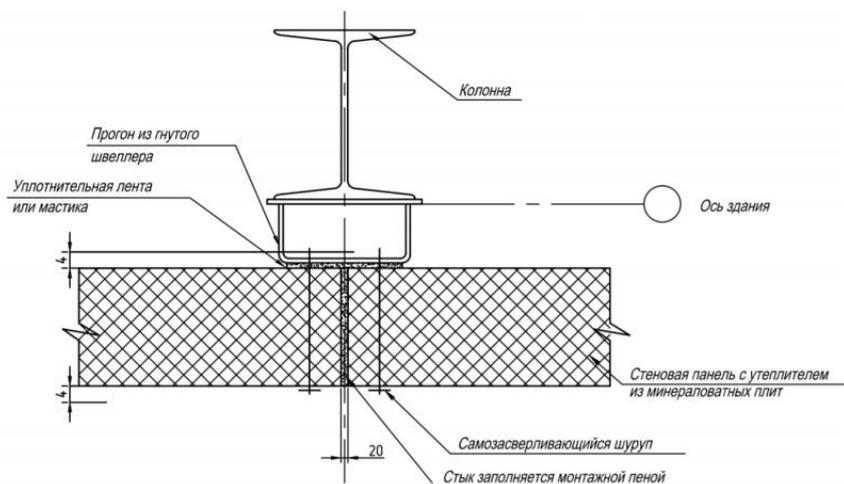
Узел крепления стеновой панели к колонне фахверга
